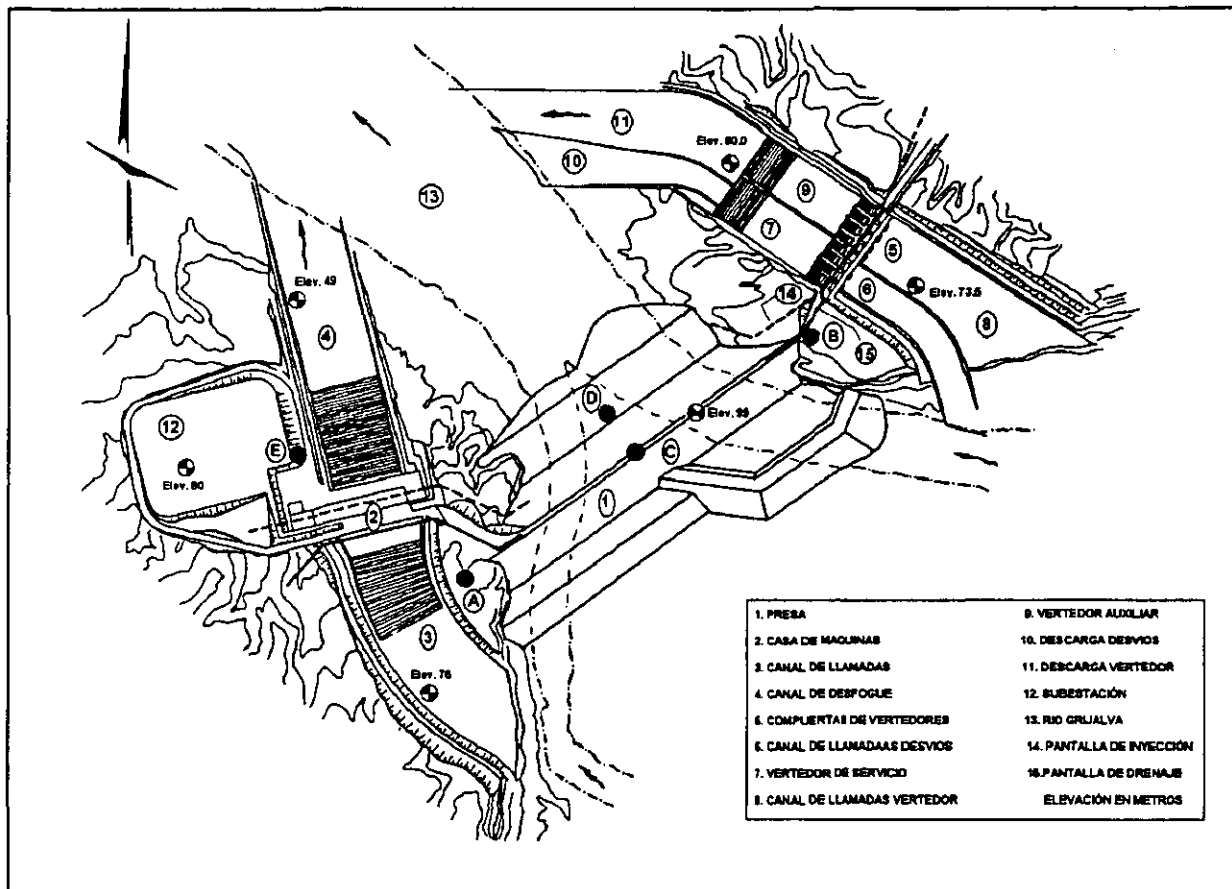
Planta general del proyecto hidroeléctrico Peñitas
